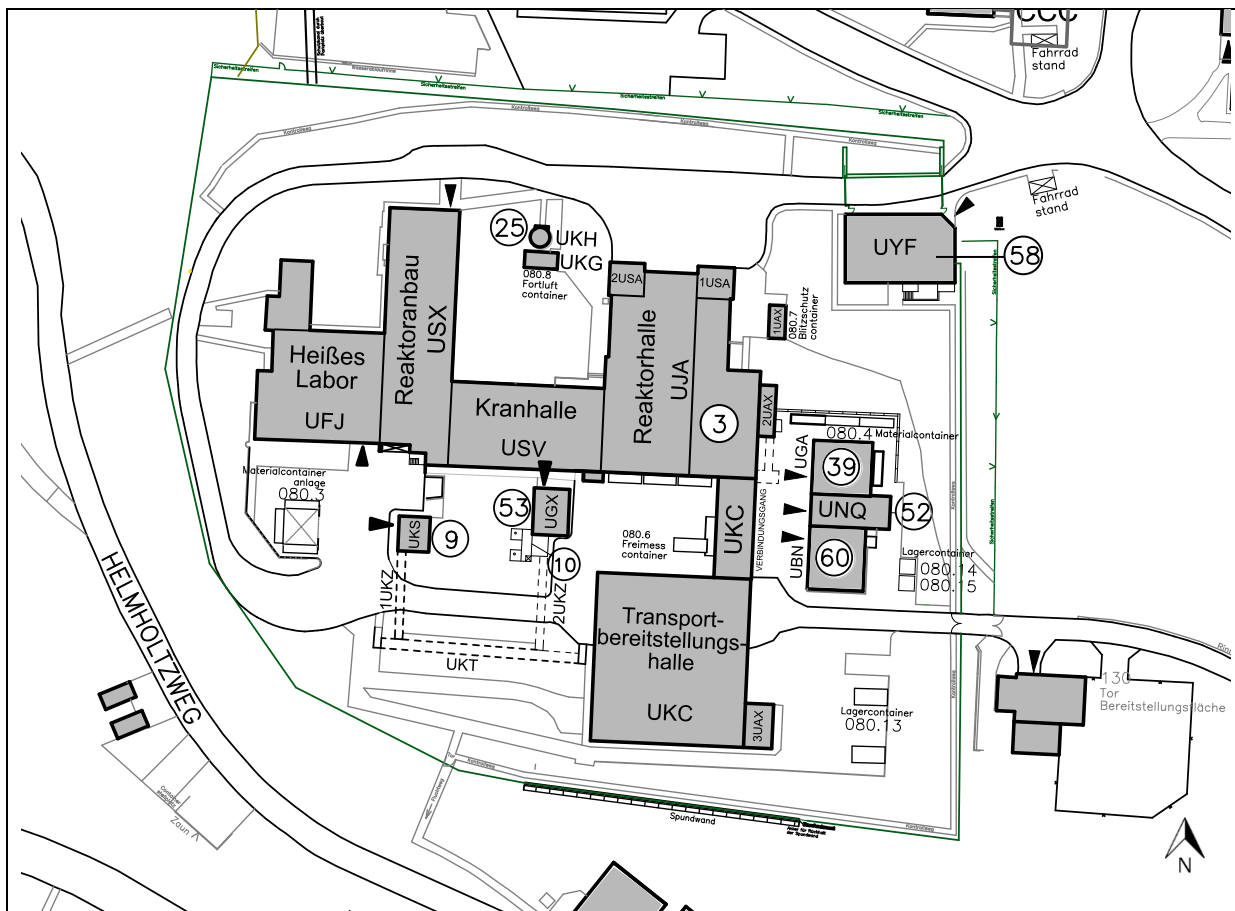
Lageplan Gebäude und Anlagenbereiche der FRG und des HL
